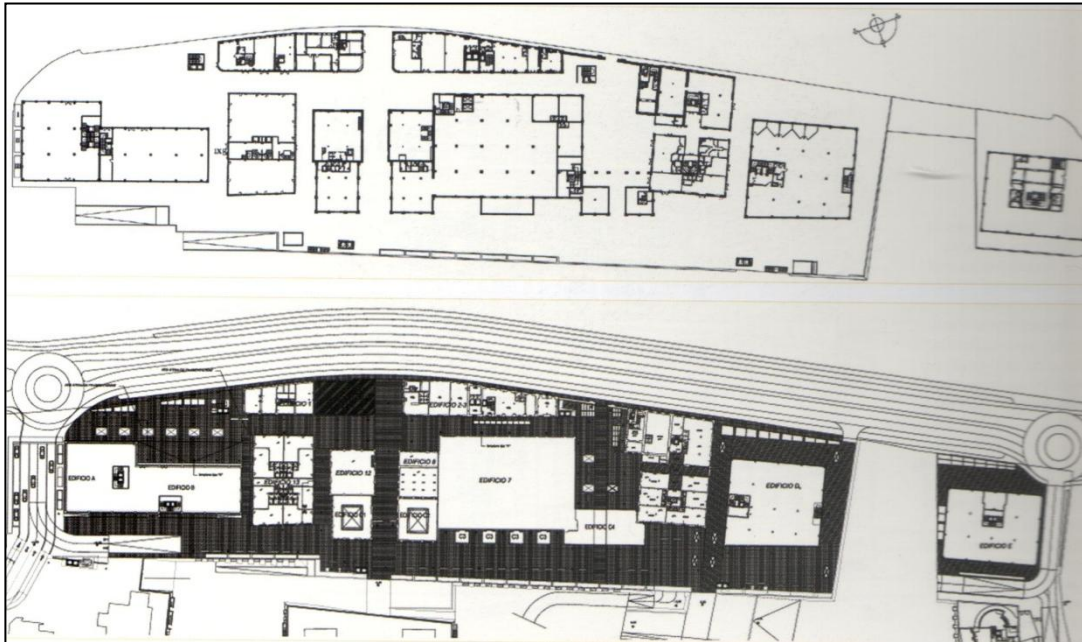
Planimetria generale delle parti oggetto di ristrutturazione con studio delle sistemazioni esterne.
